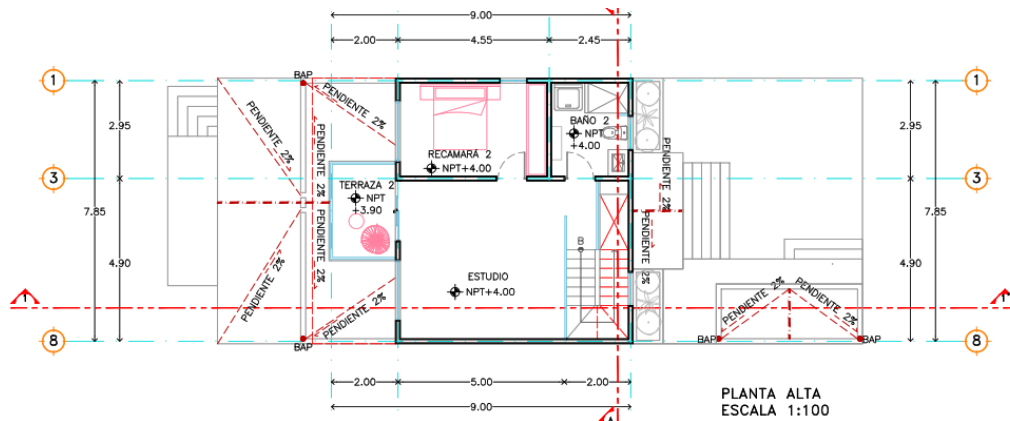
Plano arquitectónico con vista de planta alta. Como se puede observar en esta planta se construirá una recámara, estudio, baño y una terraza.
